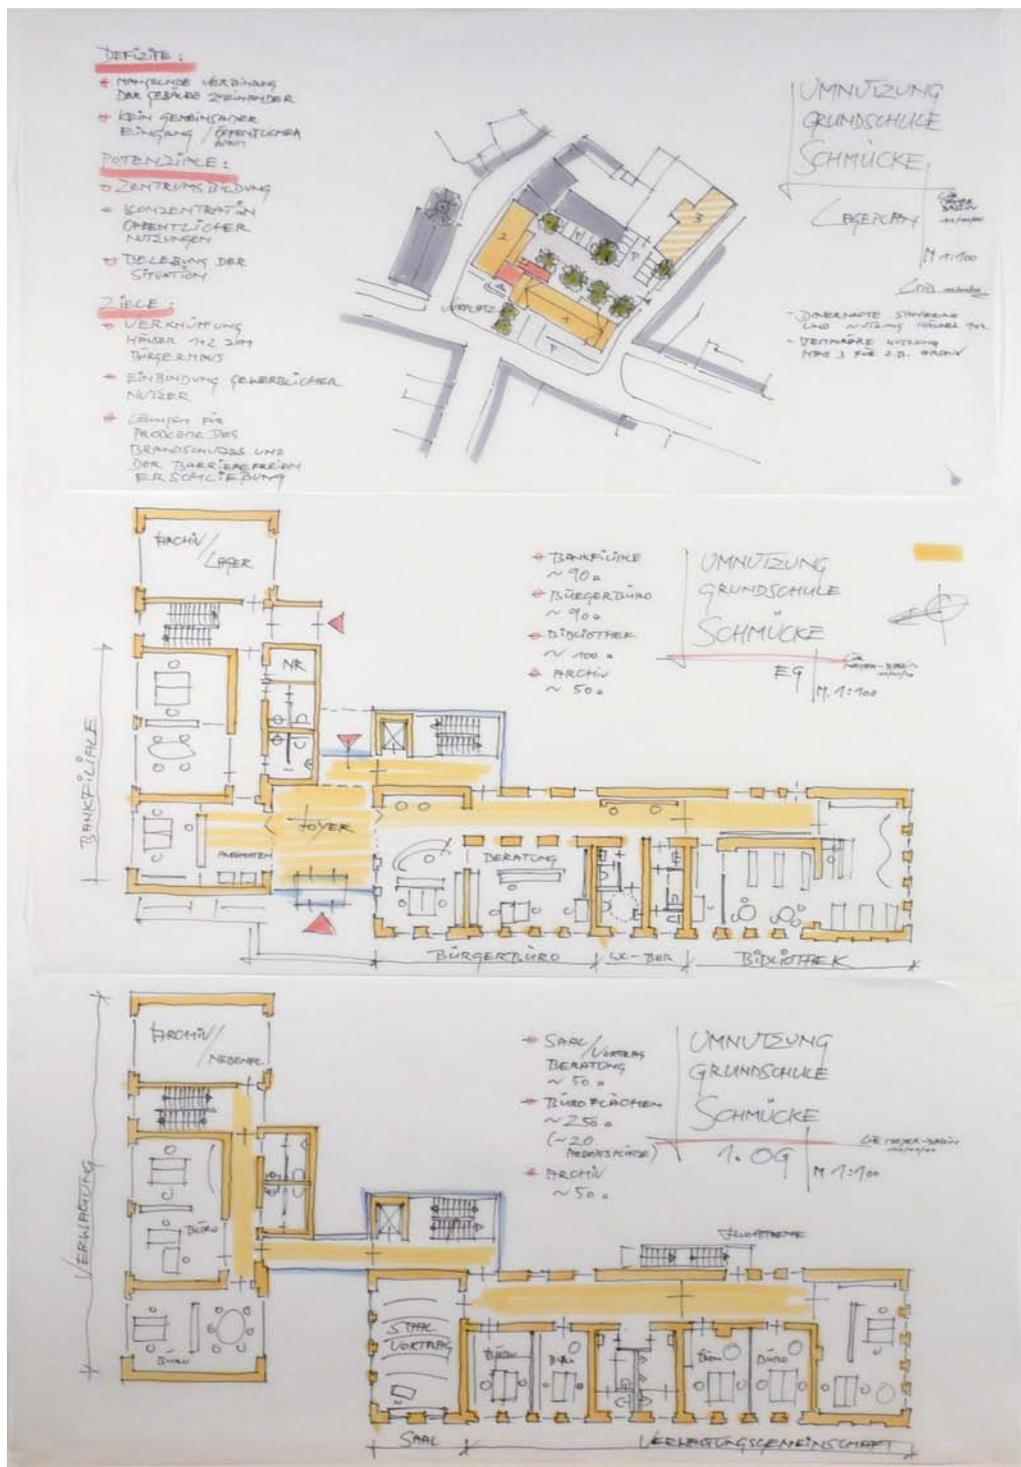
Heldrungen Grundschule Schmücke Grundrisse
